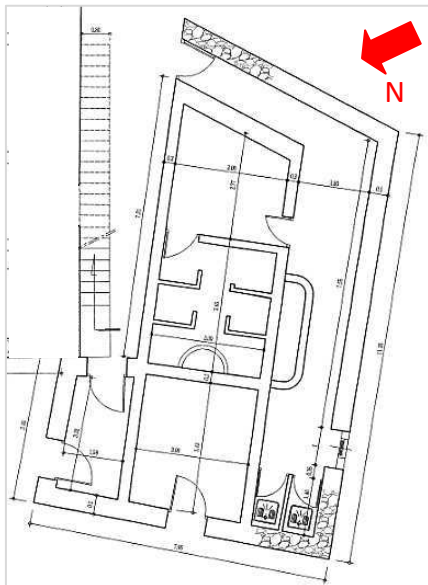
Plan de hammam du ksar avant sa démolition [30]
